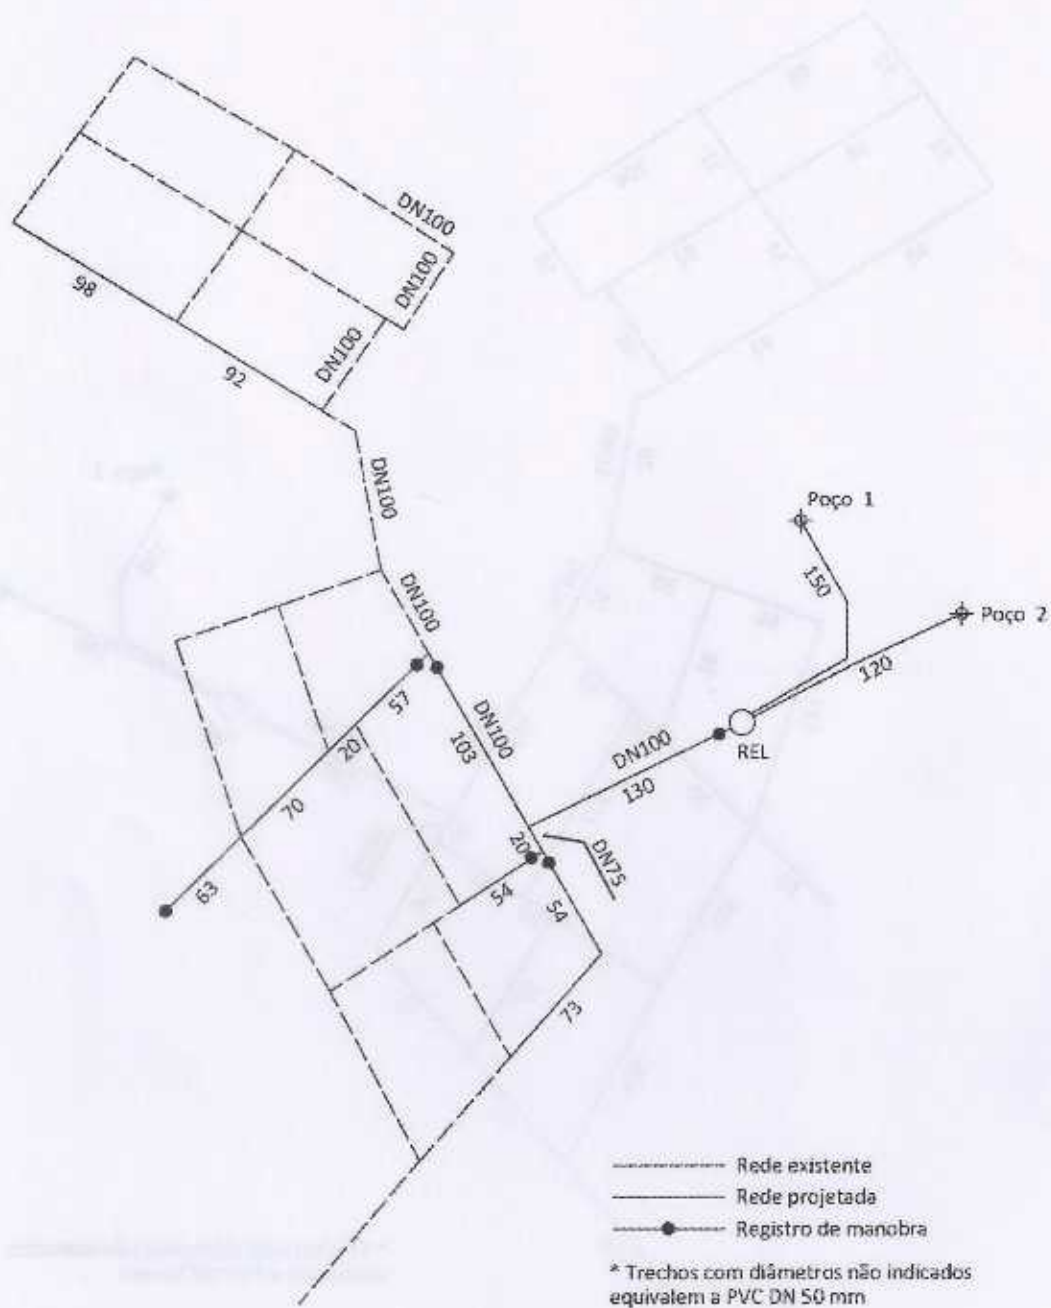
Infraestrutura de reforço do sistema de abastecimento de água Central – Loteamentos São Jorge e São Paulo.
